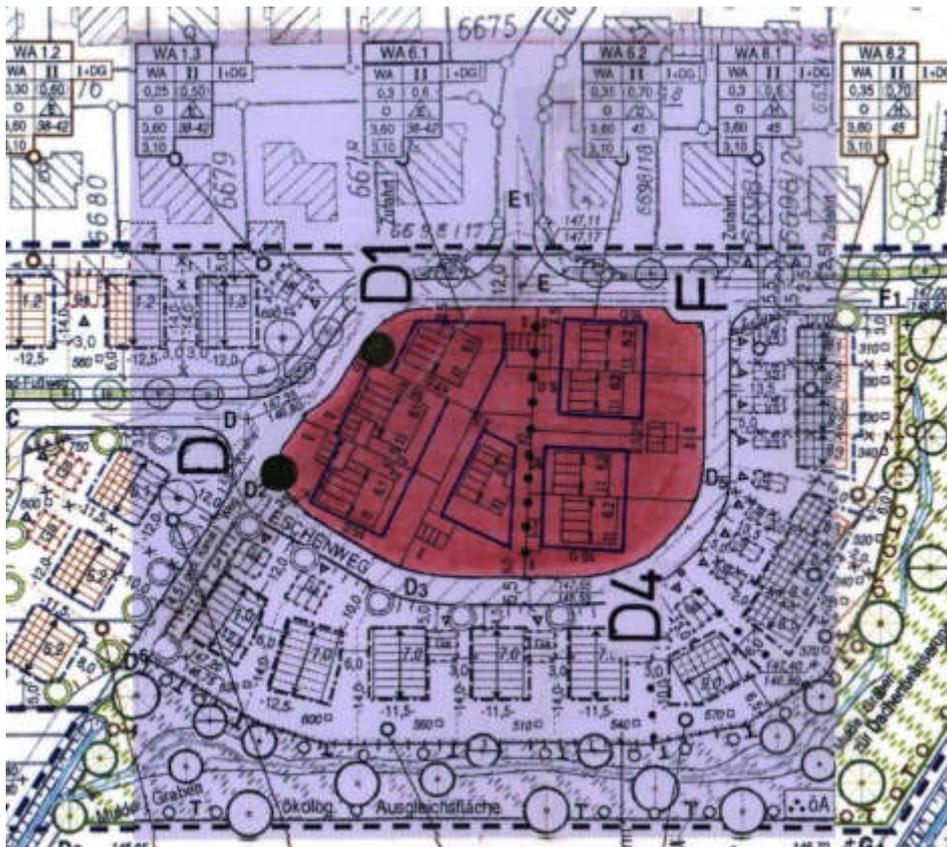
Ausschnitt aus Bebauungsplan Hanfbündt-West (S-Kurve und Einmündung Eschenweg)
